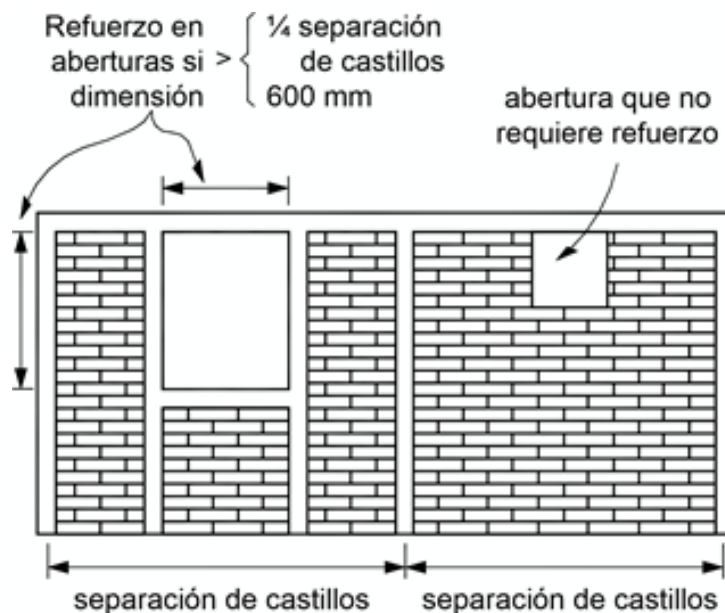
Requisitos de la construcción con mampostería confinada en aberturas.
